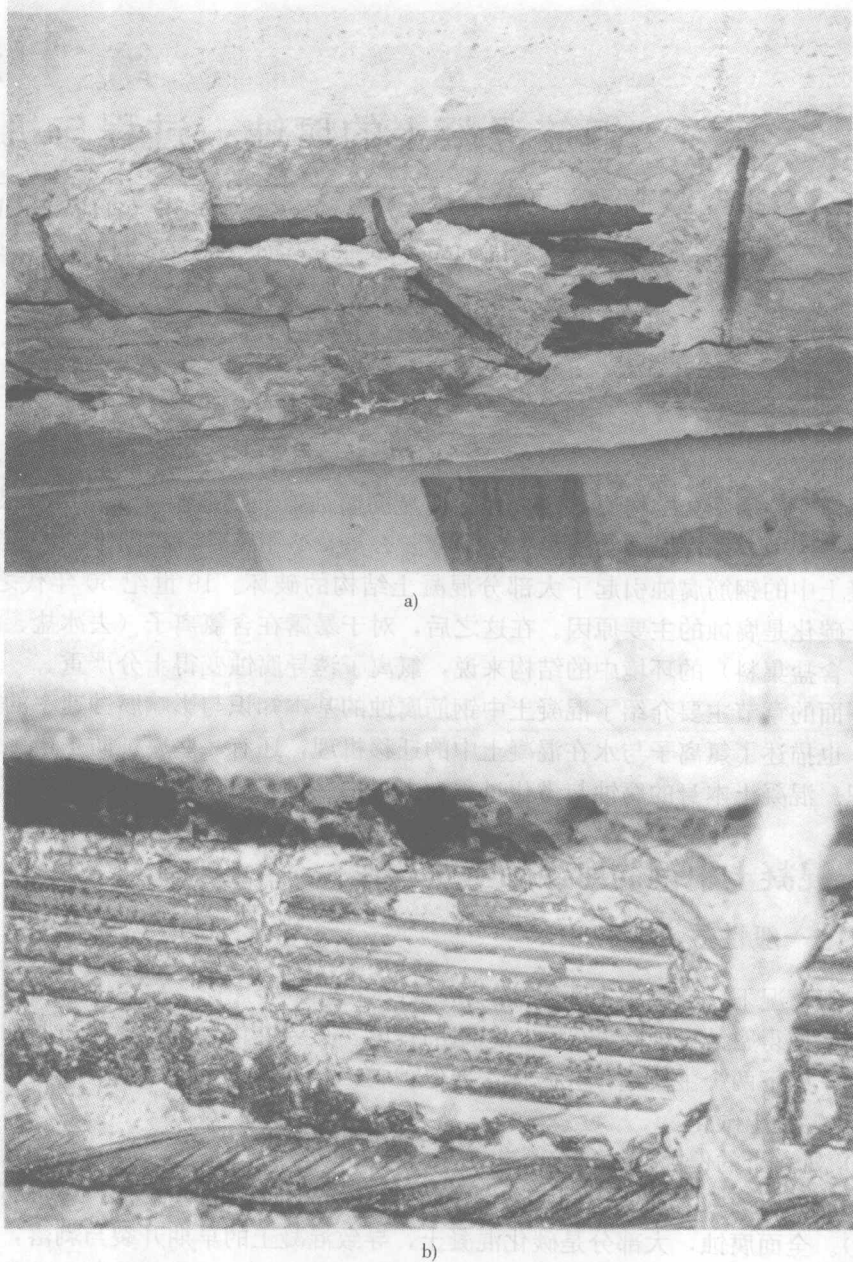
桥梁中钢筋混凝土梁的腐蚀
